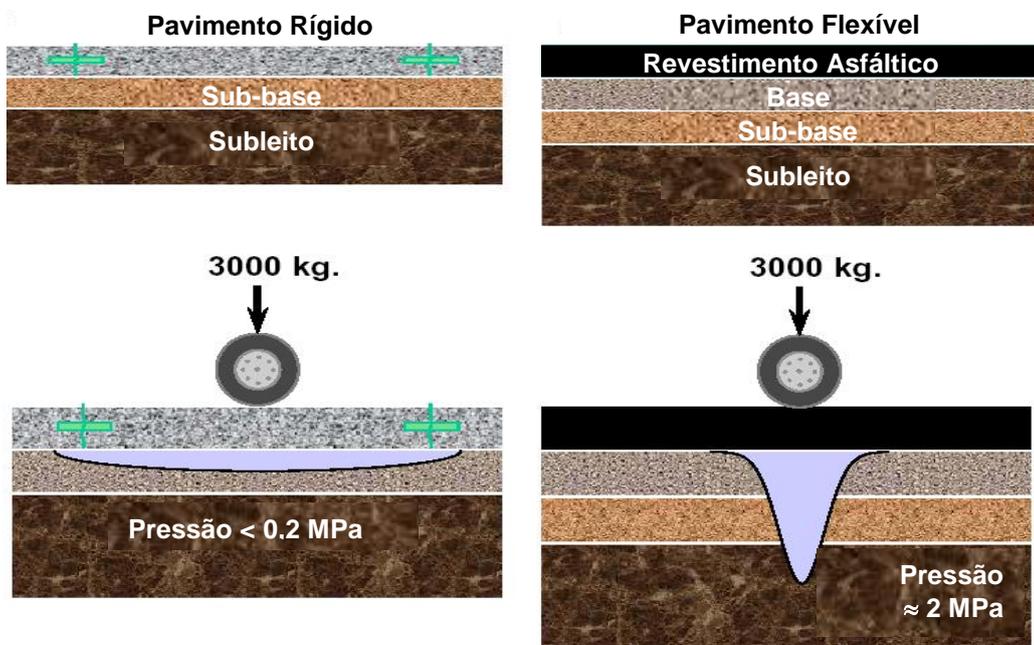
Distribuição de cargas nos pavimentos rígido e flexível.
